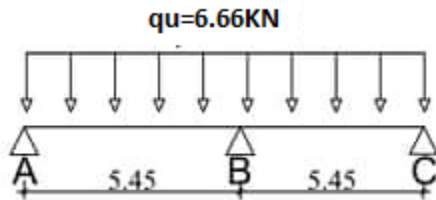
Schéma statique des poutrelles du plancher terrasse.
